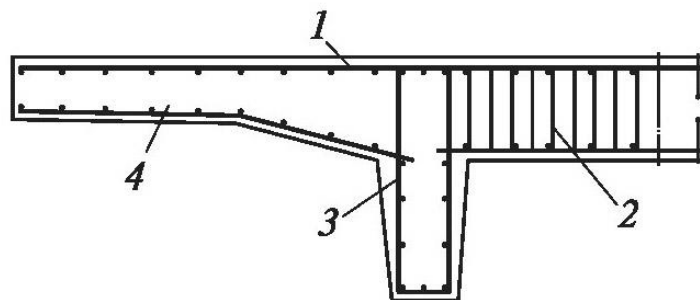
Схема армирования плитно-ребристого поперечного сечения ненапрягаемой арматурой: 1 - верхняя сетка плиты проезжей части; 2 - продольная арматура и хомуты поперечного ребра; 3 - арматурный каркас продольной балки; 4 - нижняя сетка консолей проезжей части
